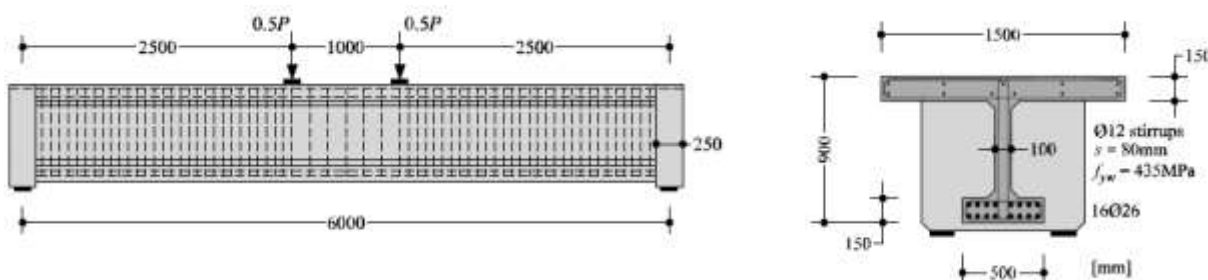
Geometria e armaduras de corte e flexão da viga T1 testada por Leonhardt e Walther [23].
